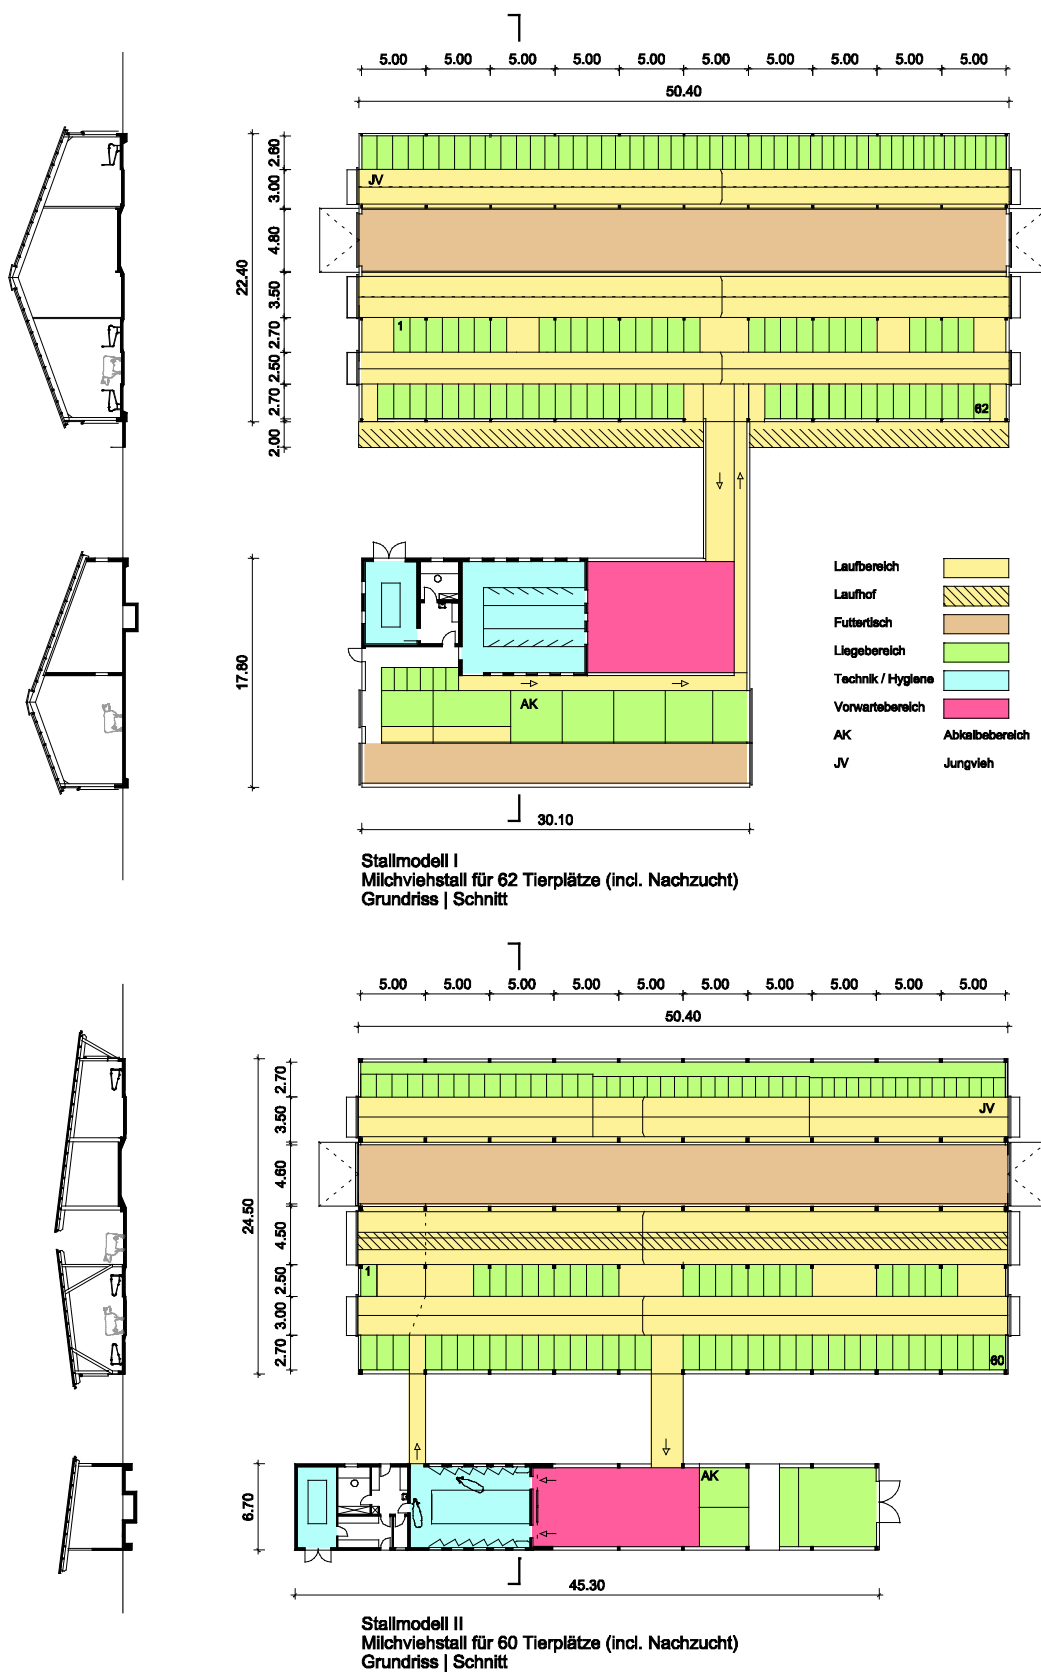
Grundrisse und Schnitte für zwei Stallanlagen mit 62 bzw. 60 Milchviehplätzen (incl. eigener Nachzucht) in ein- und mehrhäuser Bauweise
